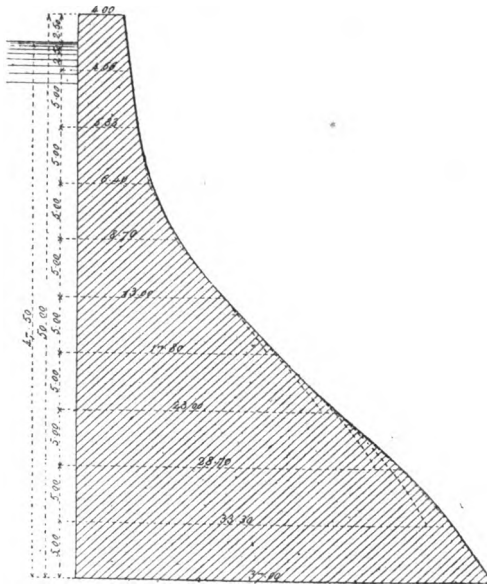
Profil-type de barrage, d'après M. Guillemain.
